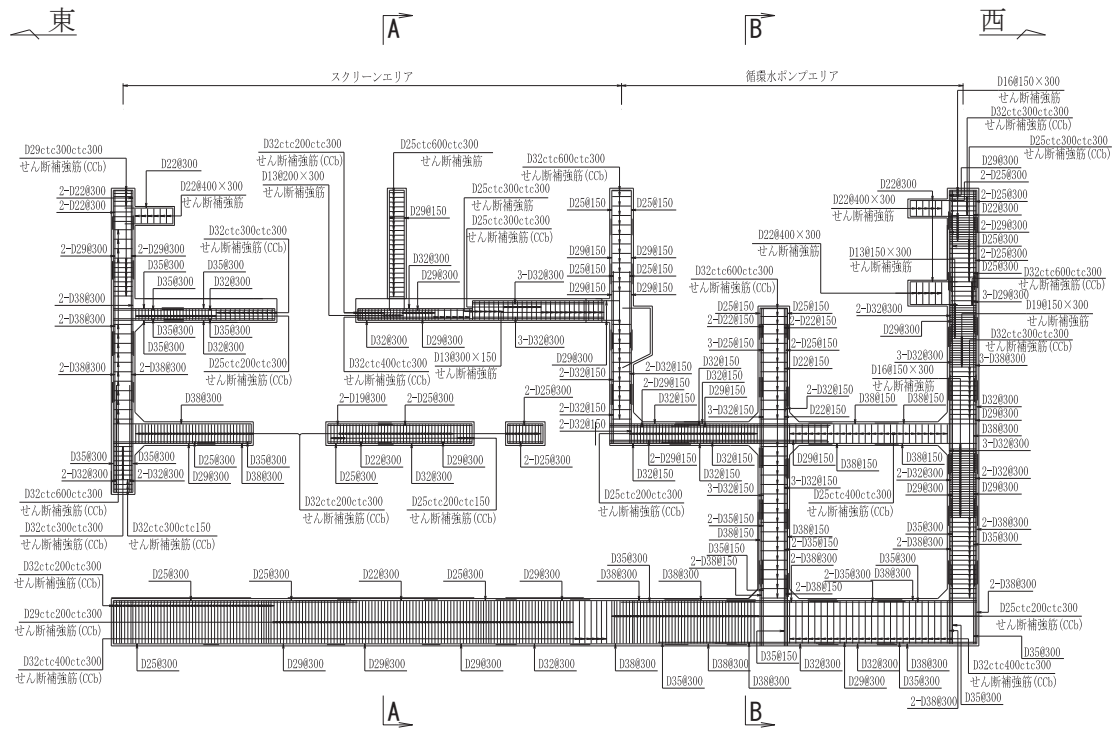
第 3 号機海水ポンプ室概略配筋図 (C-C 断面)
